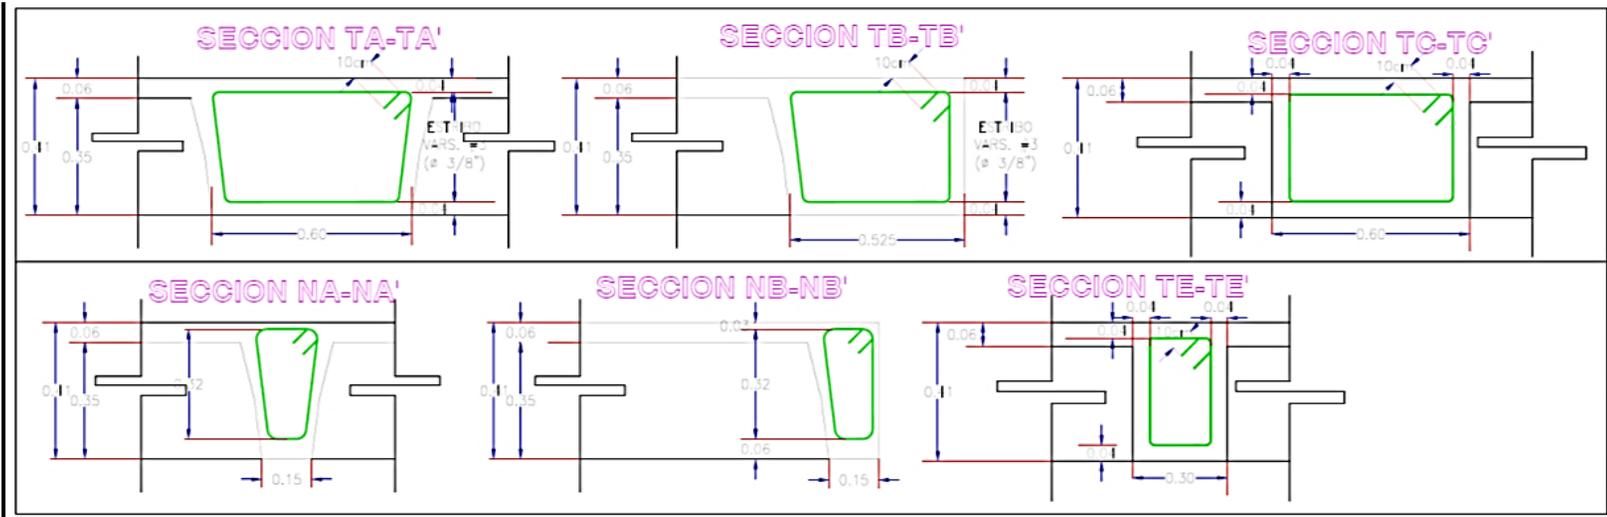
Plano estructural de losa de entepiso armado de traves principales y nervaduras.
